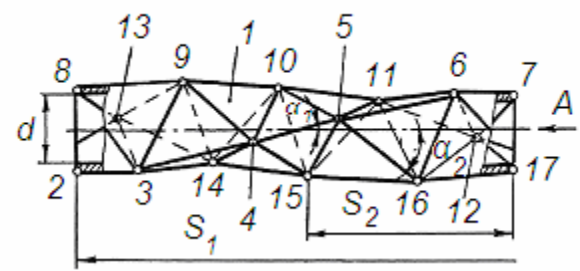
Цилиндрический винтовой агрегат с тремя ломанными винтовыми линиями основного направления и двумя ломанными линиями противоположного направления (вид спереди)
